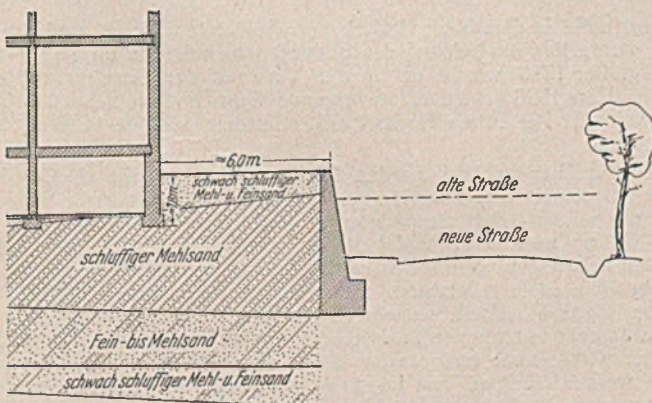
Querschnitt durch Bauwerk, Baugrund und Straße.
